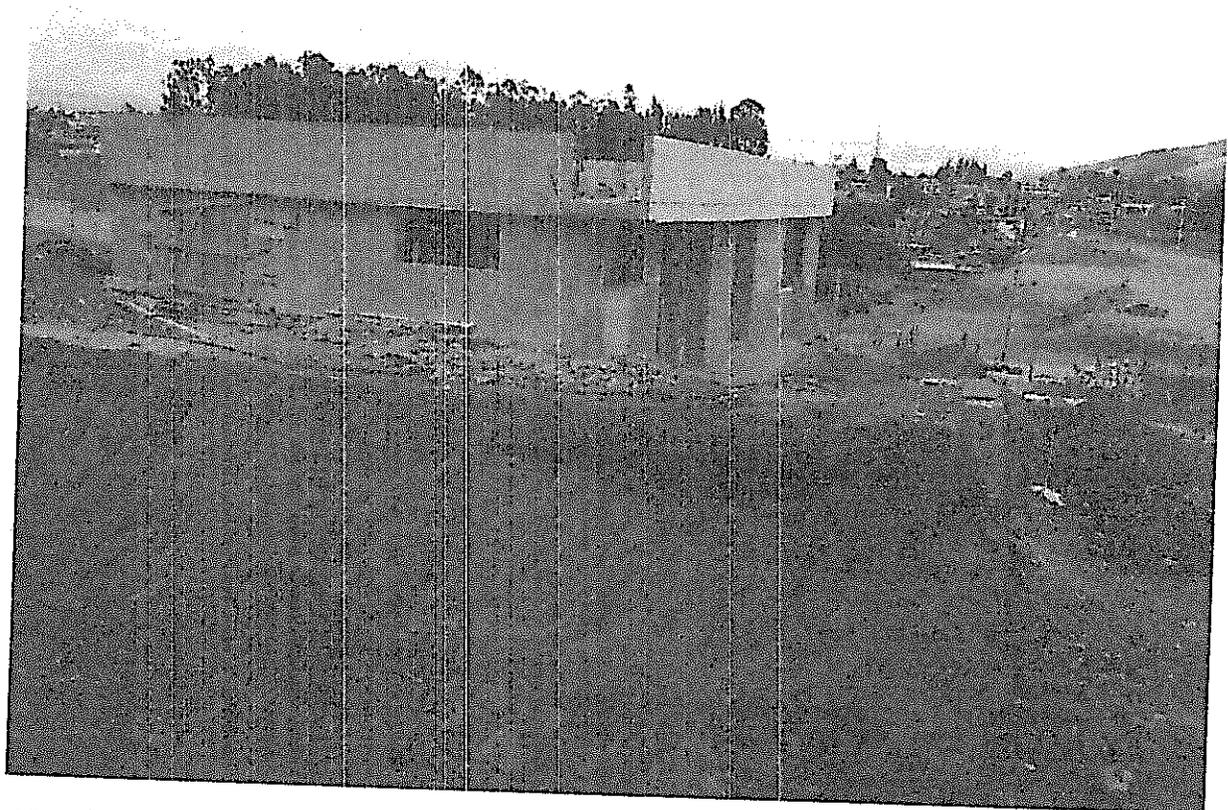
APERTURA DE CALLE SUR 12 METROS SEPARA IMPRENTA Y FAMILIA RÍOS,
